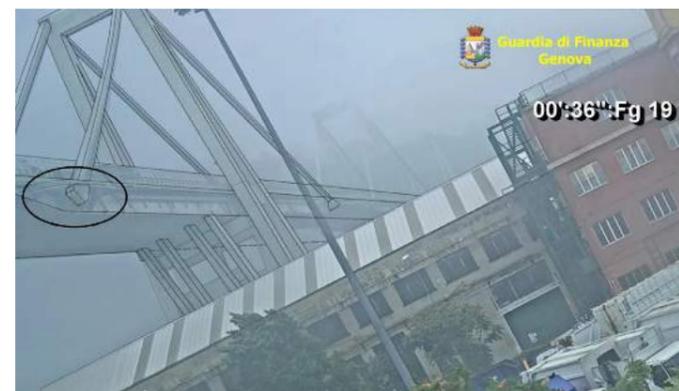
Abbassamento campata con fulcro sui pilastri obliqui
